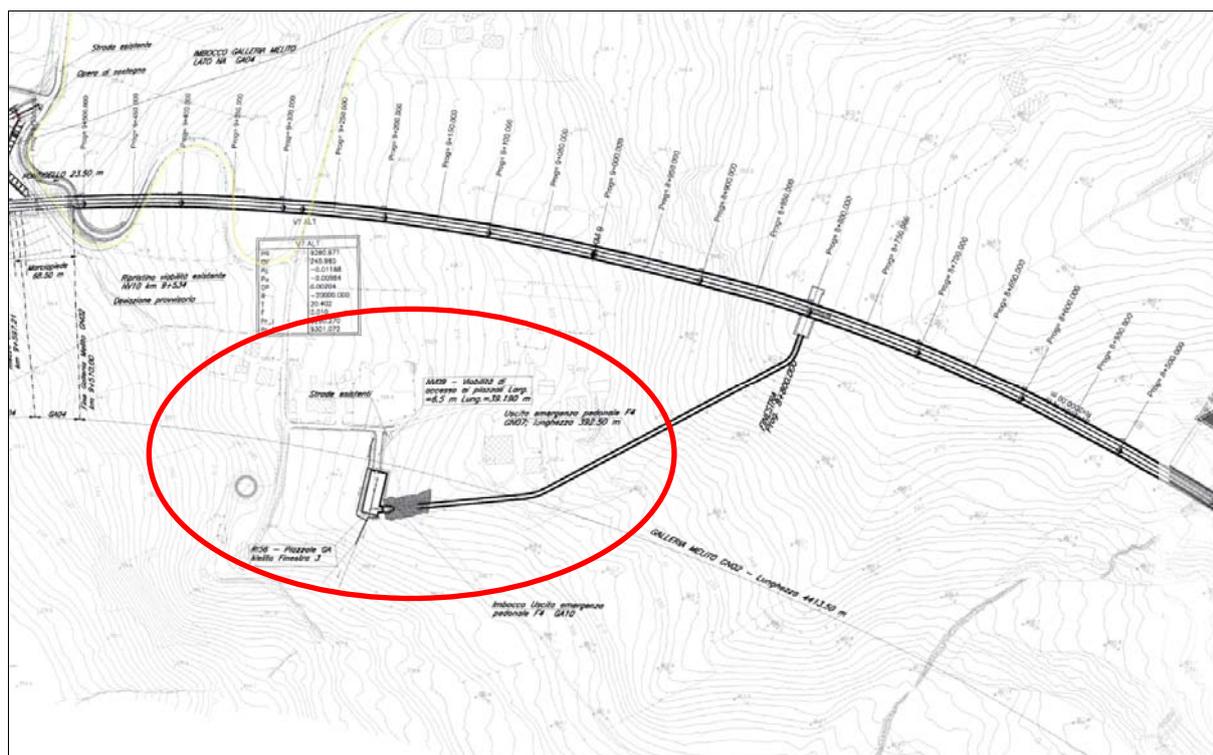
Stralcio planimetrico con l'individuazione dell'intervento
